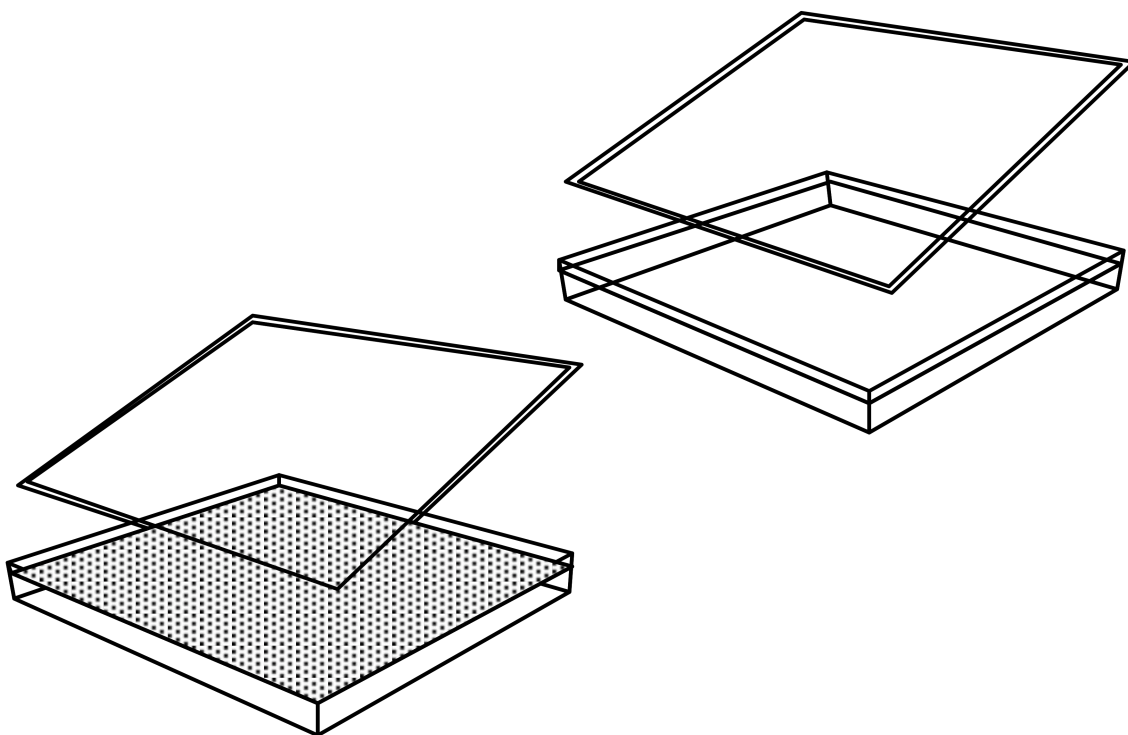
Prinzipielle 3-D-Ansicht der Flachdach-Fundationsschalen SOLight; rechte obere Fundationsschale ist schematisch leer dargestellt, die linke untere schematisch mit Dachkies aufgefüllt
